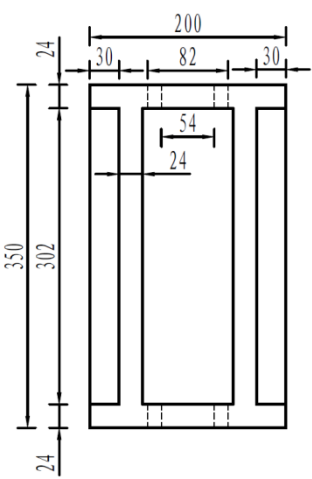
临时拉杆反力架截面构造示意图 (mm)
